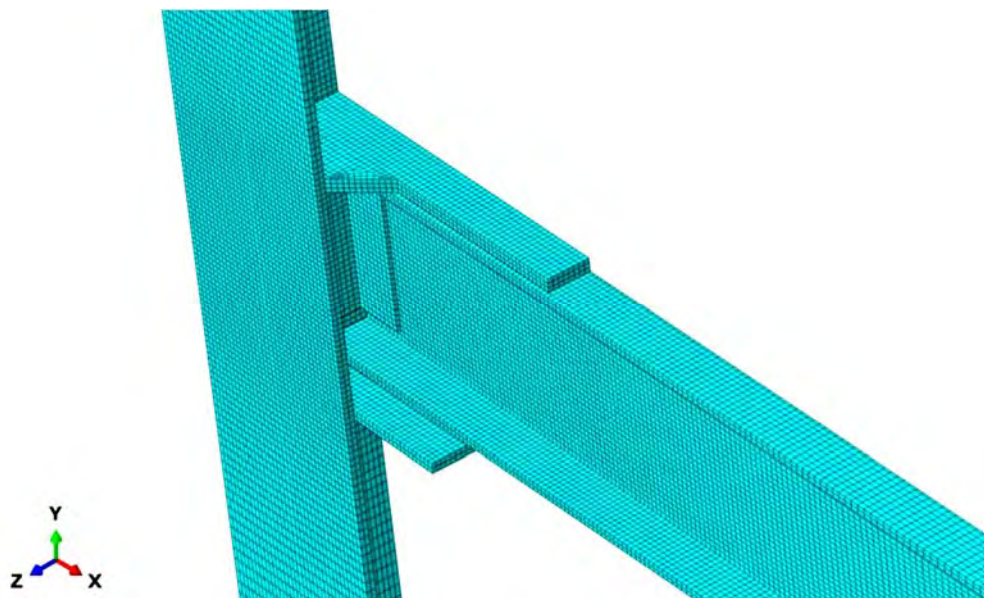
Mallado seleccionado para la conexión soldada llegando al alma de la columna.
